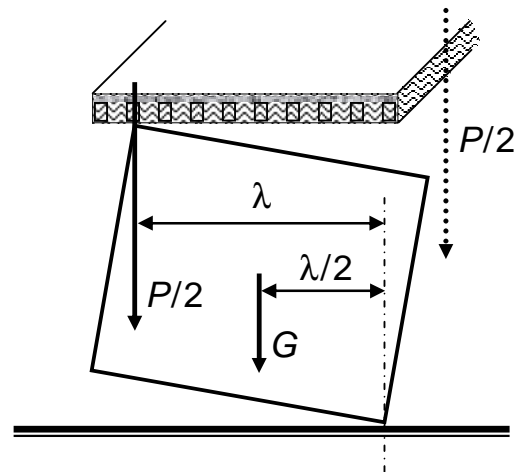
e. Il solaio con cordolo trasmette metà carico al muro in condizione di meccanismo rotazionale nel proprio piano, e metà carico alla striscia muraria rimasta in assetto verticale. Il solaio con cordolo scarica dunque la forza $P/2$ (linea continua) al muro in rotazione e la forza $P/2$ (linea punteggiata) al muro ortogonale. Il cordolo modifica così l'orditura naturale data dai travetti relativamente alla risposta sismica. Mentre in campo statico il solaio non scarica sul muro ortogonale ma scarica soltanto sui muri porta-travetti, infatti, in campo dinamico (vibrazione nel piano del muro) il solaio scarica per metà anche sul muro ortogonale.
